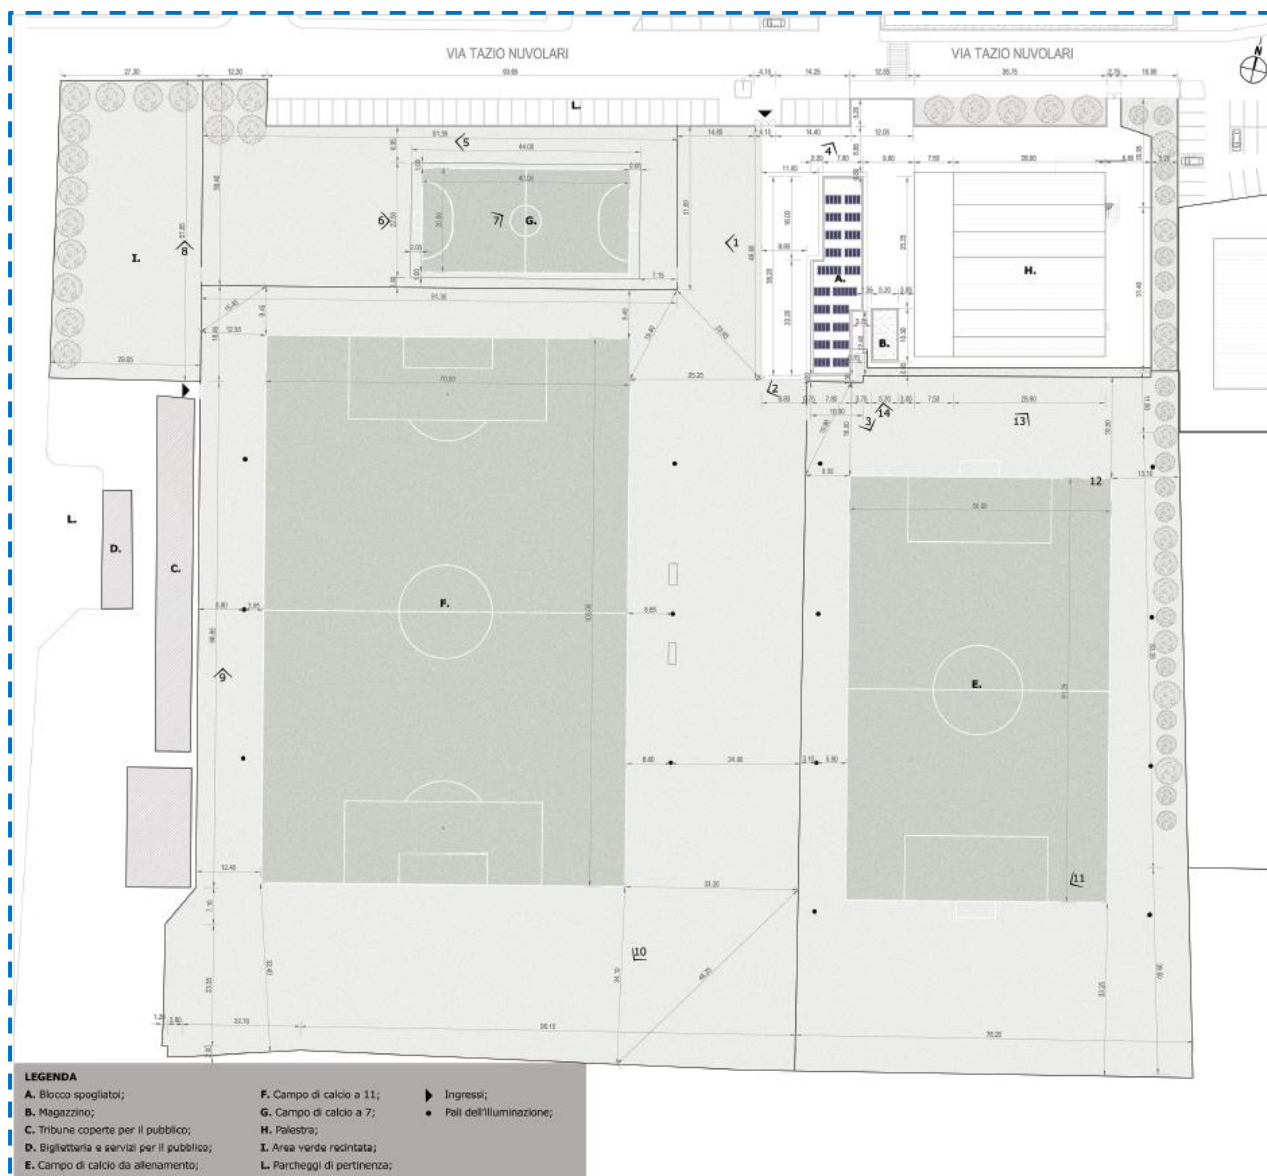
Estratto Tav.A.02.a Rilievo dello stato di fatto
